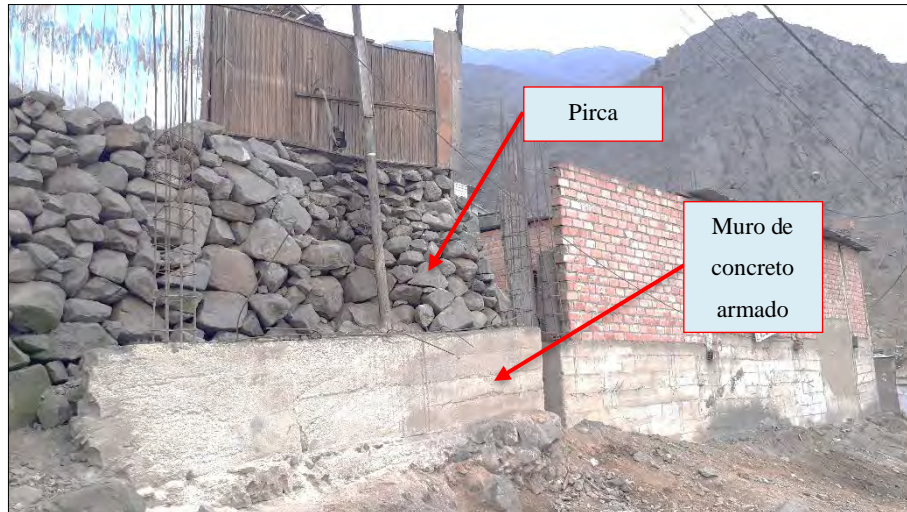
Vivienda con muro de concreto armado sobre pirca – distrito de Carabaylo
